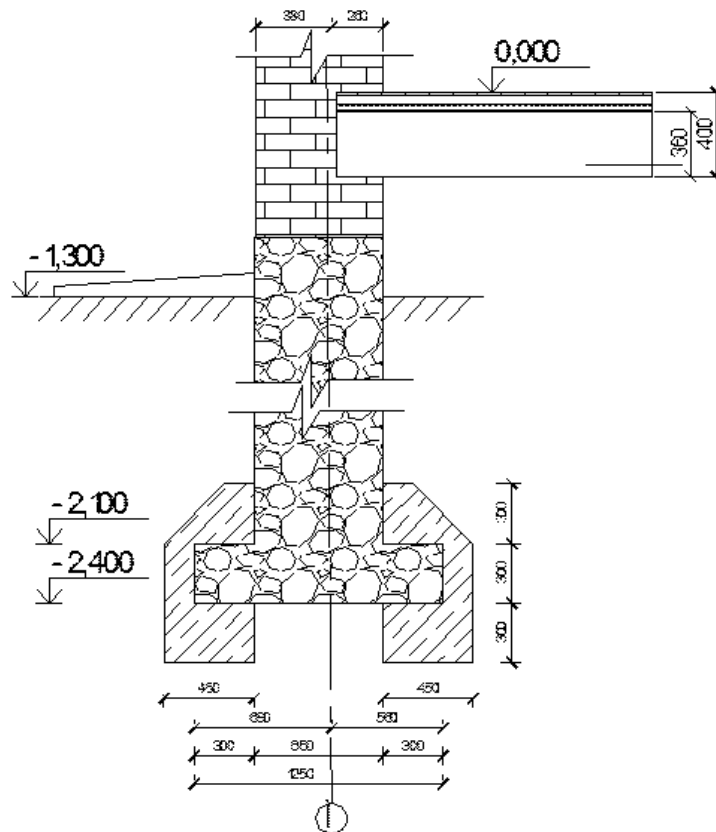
Усиление фундамента под внутреннюю стену с использованием ж\б вставок и защита стены фундамента обмазочной гидроизоляцией.
